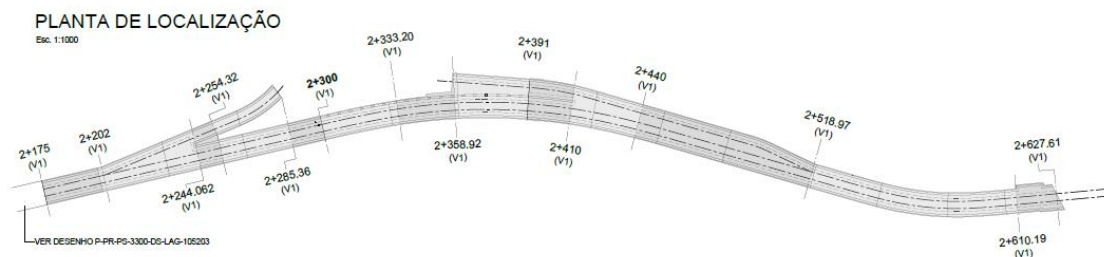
Planta de Localização de Acesso ao PMO
